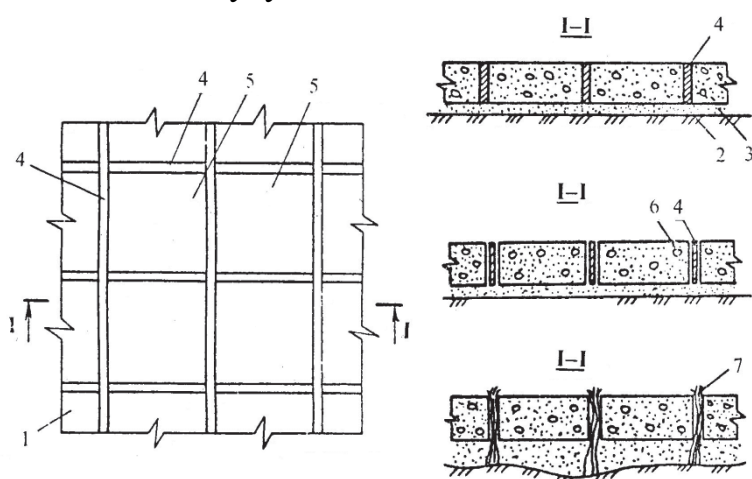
Способ возведения монолитных бетонных покрытий [авт. св. № 1633053]
